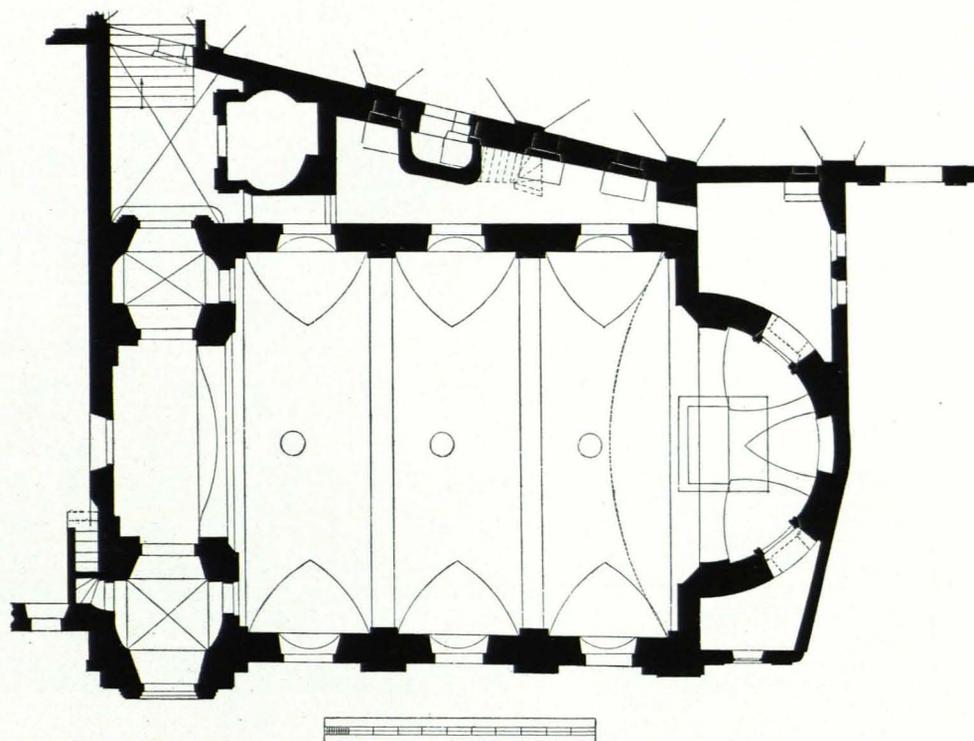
Sebastianskirche, Grundriß 1 : 300 (S. 125)
